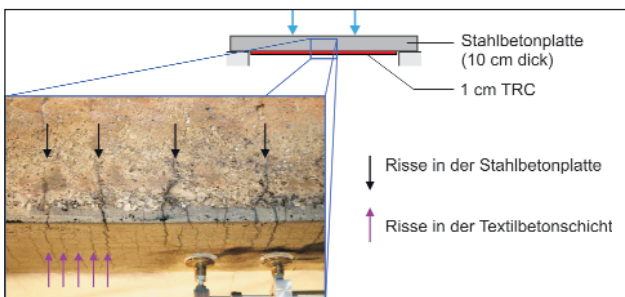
Rissbild einer mit TRC verstärkten Stahlbetonplatte nach einem 4-Punkt-Biegeversuch (durchgeführt von Weiland und Curbach [6])
